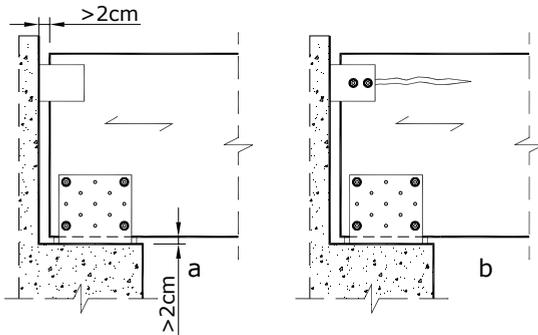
a: corretto; b: sbagliato. Nello schema di appoggio semplice di struttura isostatica, schema largamente utilizzato, è necessario vincolare l'estremità superiore della trave contro lo svergolamento (inflexione laterale), tuttavia è necessario consentire la rotazione della testa con conseguente allontanamento ed avvicinamento dello spigolo superiore rispetto alla parete della sede di appoggio; la presenza di unioni meccaniche all'estradosso può innescare lo spacco sia a causa del movimento impedito ma anche a causa del ritiro del legno ortogonalmente alla fibratura. E' sempre necessario lasciare una intercapedine su tutti i lati della testa di almeno 2cm al fine di consentire il deflusso delle acque e scongiurare l'accumulo di sporcizia.
